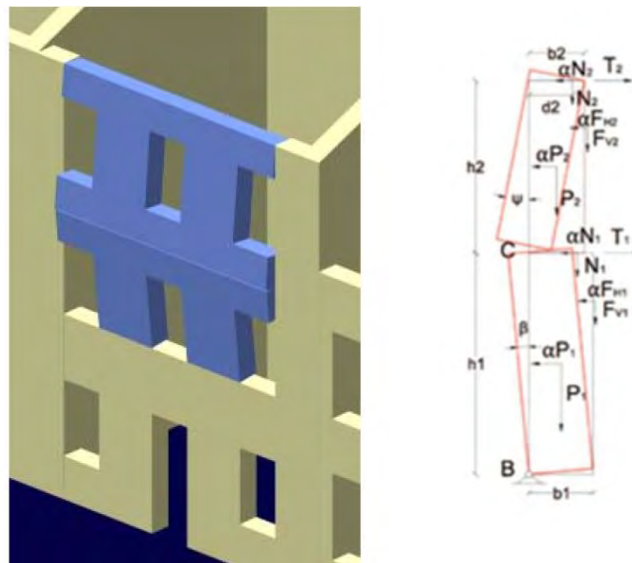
Meccanismo di flessione verticale di parete e schema di calcolo
